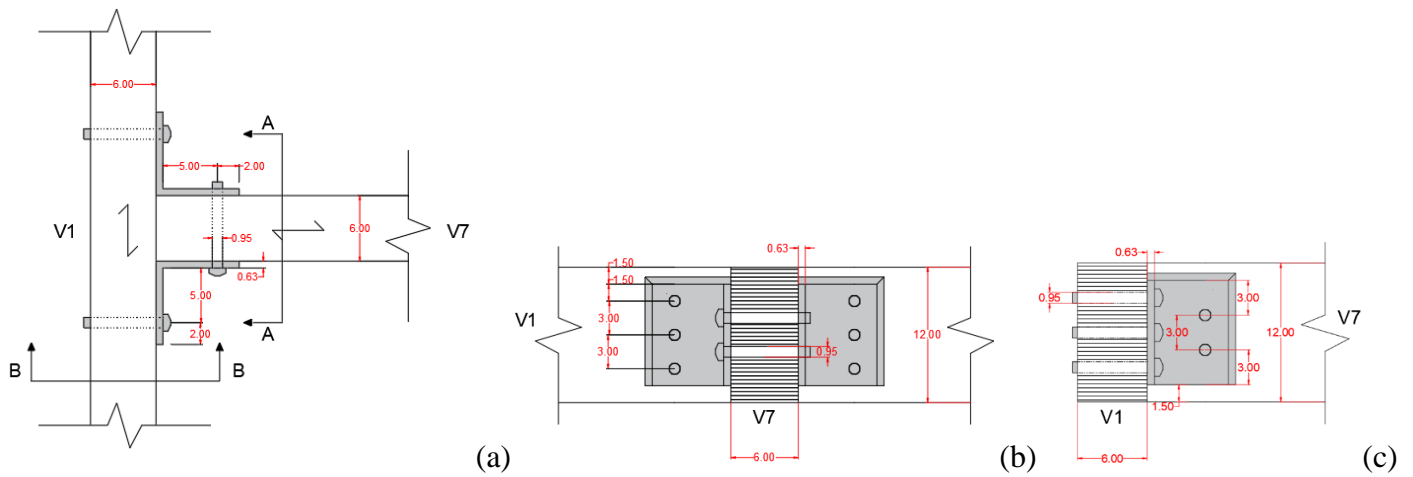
Ligação viga-viga: (a) Vista superior. Detalhe; (b) Corte A-A; (c) Corte B-B
